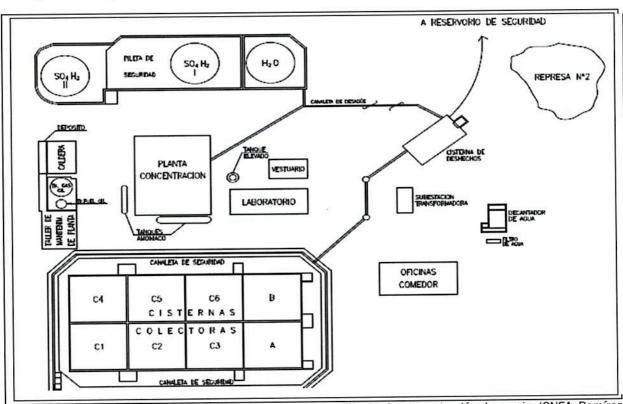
Vista general de las instalaciones exteriores de la Planta de concentración de uranio. (CNEA: Ramírez Santis et al., 2010)
